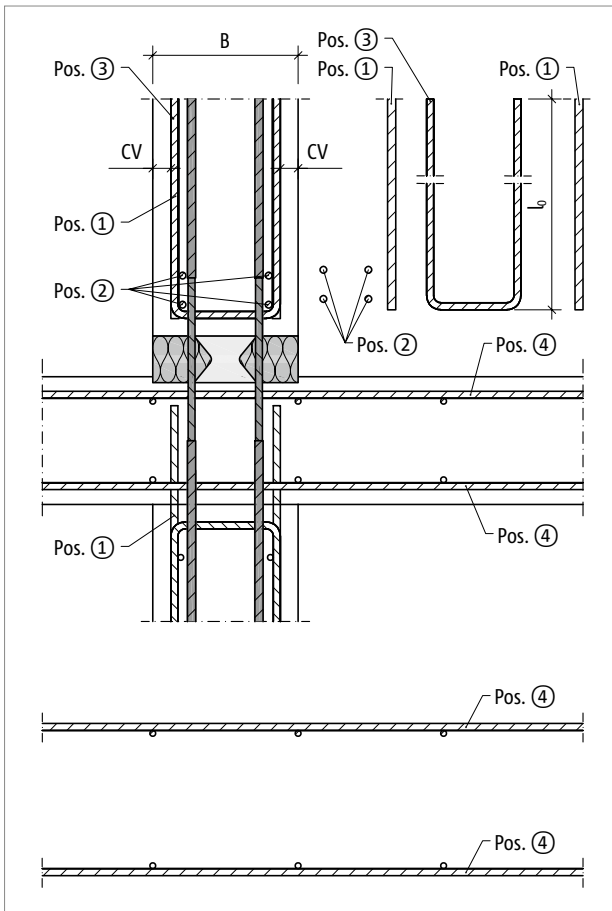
Schöck Sconnex® Typ W-NT-L: Bauseitige Bewehrung bei Zugkraftverankerung
